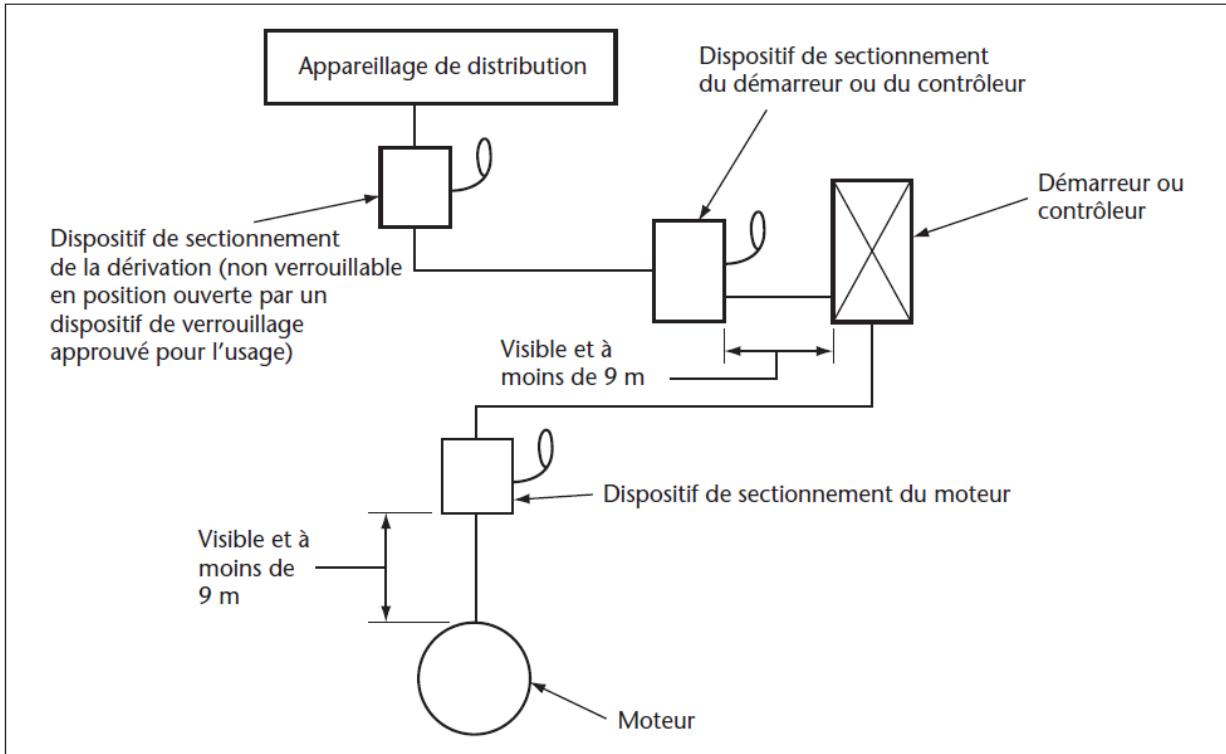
Installation et emplacement du dispositif de sectionnement
